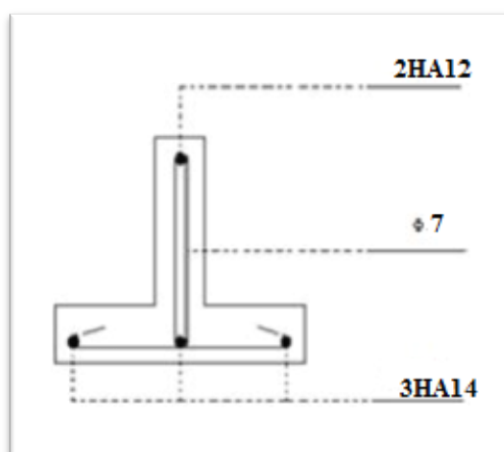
Schéma de ferrailage d'un plancher terrasse.
